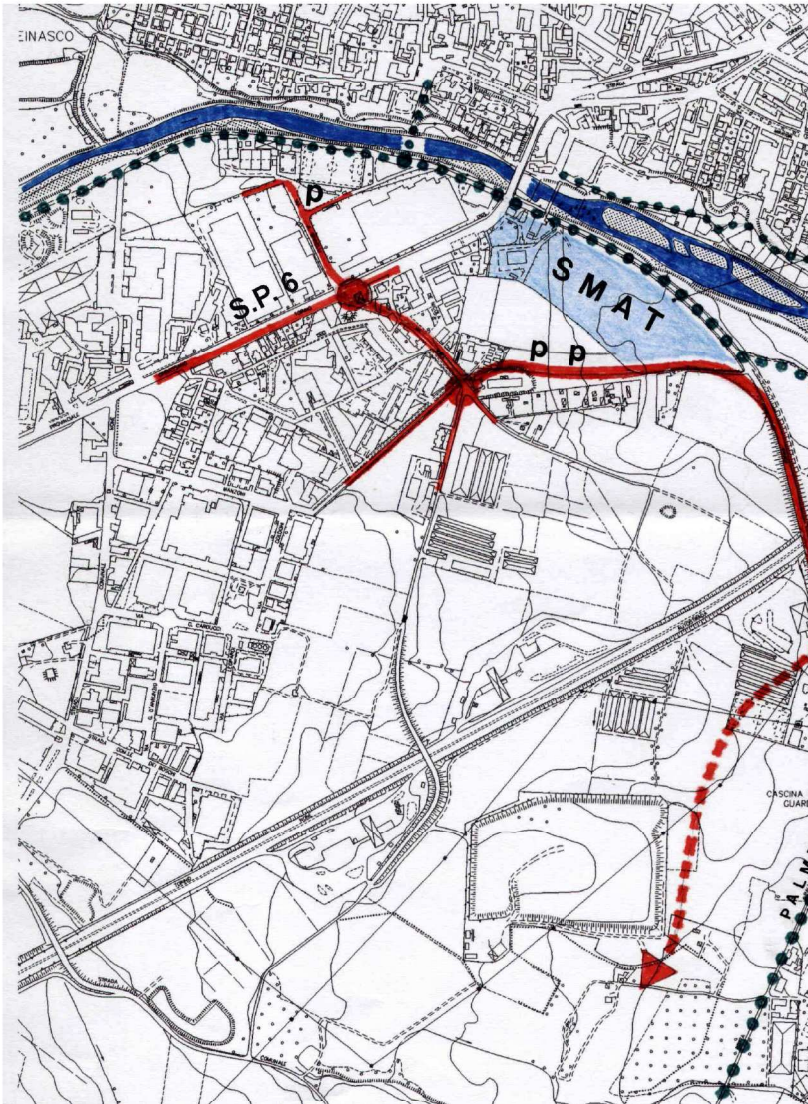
Proposta di immissione sulla S.P. 6 a sud est dell'attuale intersezione del tracciato veicolare di collegamento fra la frazione di Borgaretto con il Concentrico di Beinasco.
